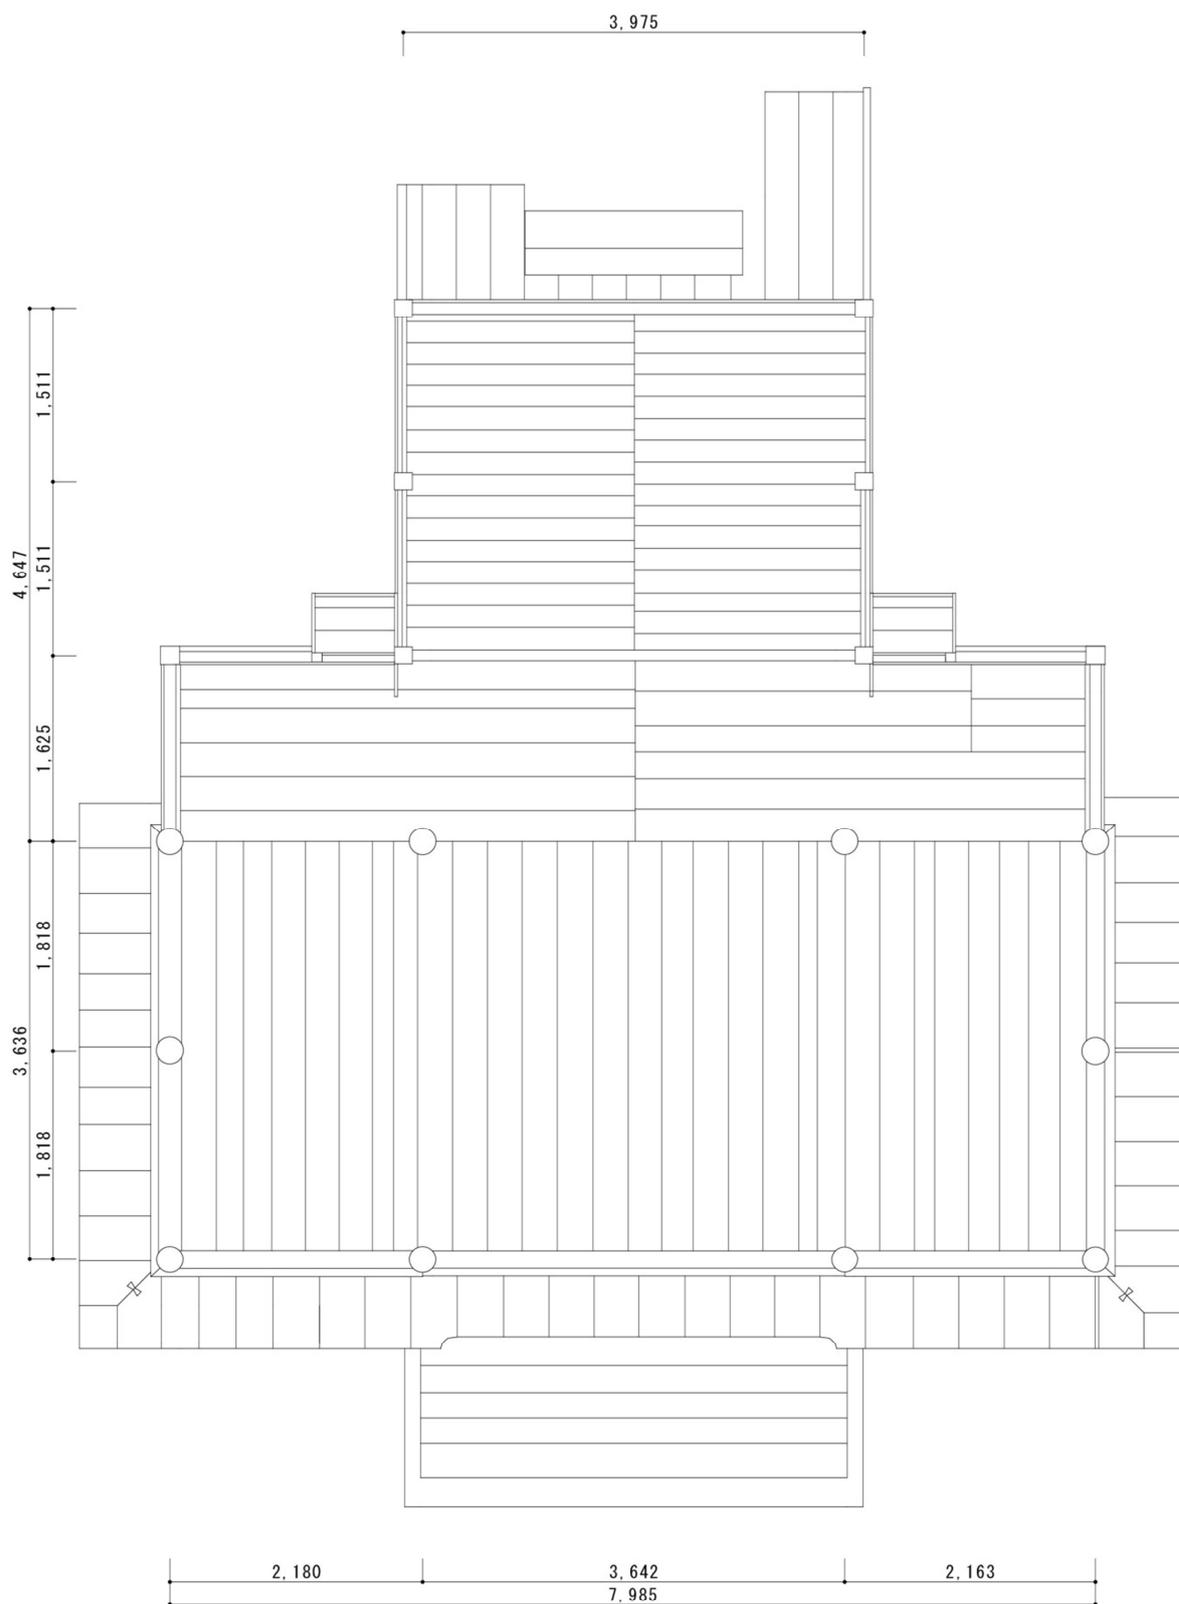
二宮八幡神社拝殿・申殿 平面図 1/50
